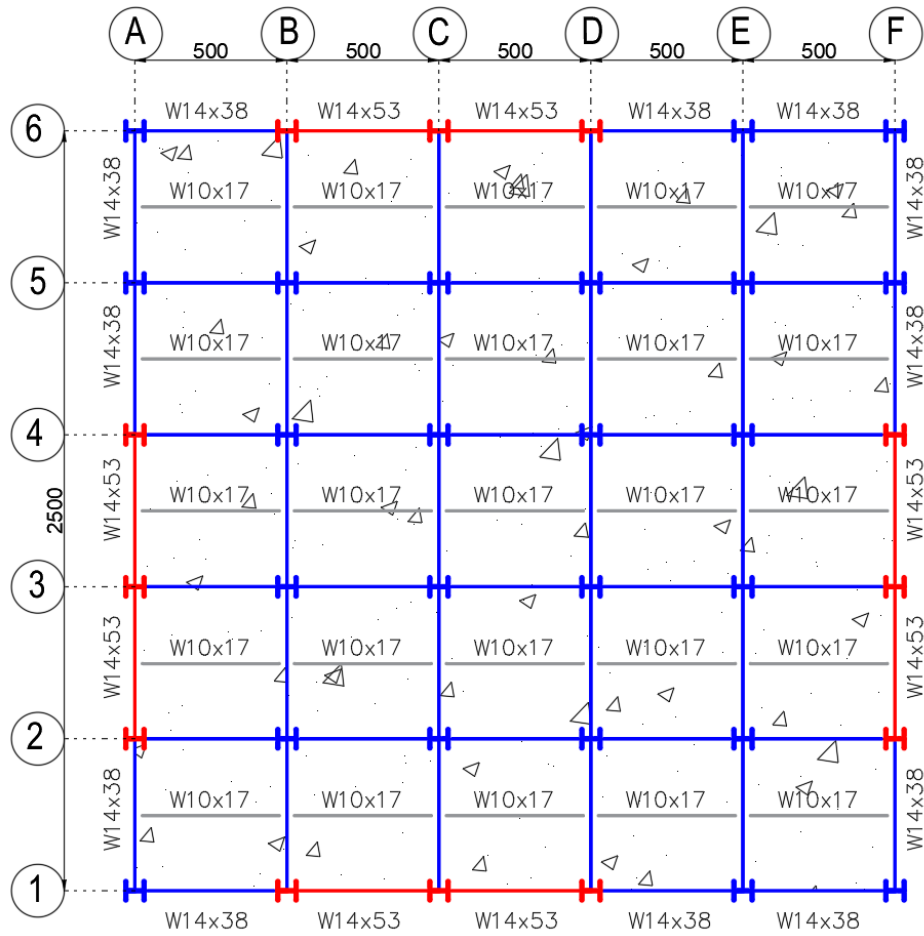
Vista en planta del edificio de 4 pisos – marco SCBF.
